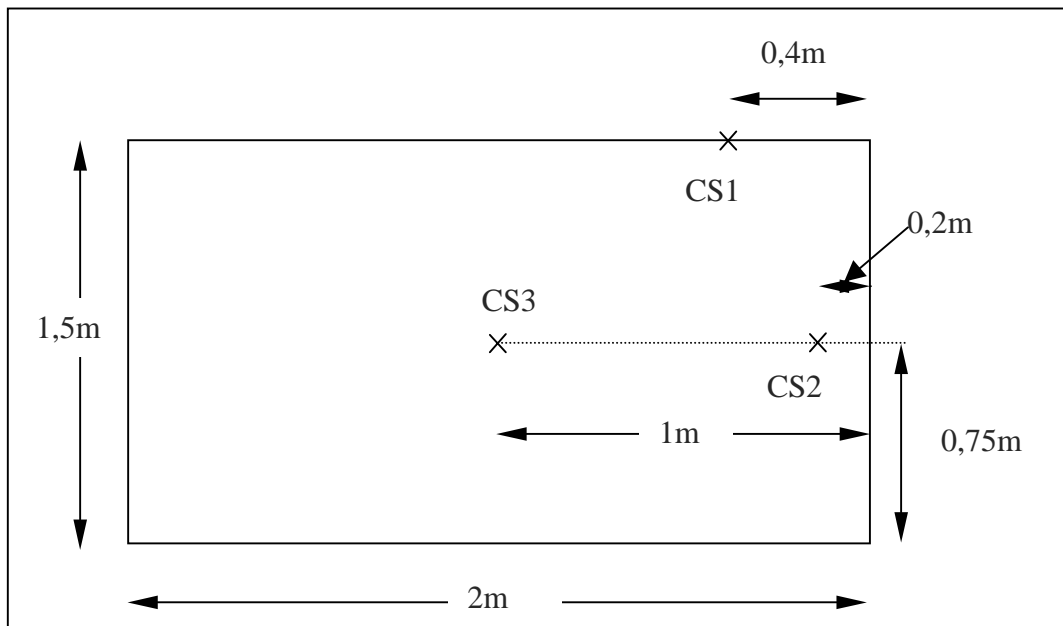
Vue de dessus de la dalle en béton armé et de la position des cibles
